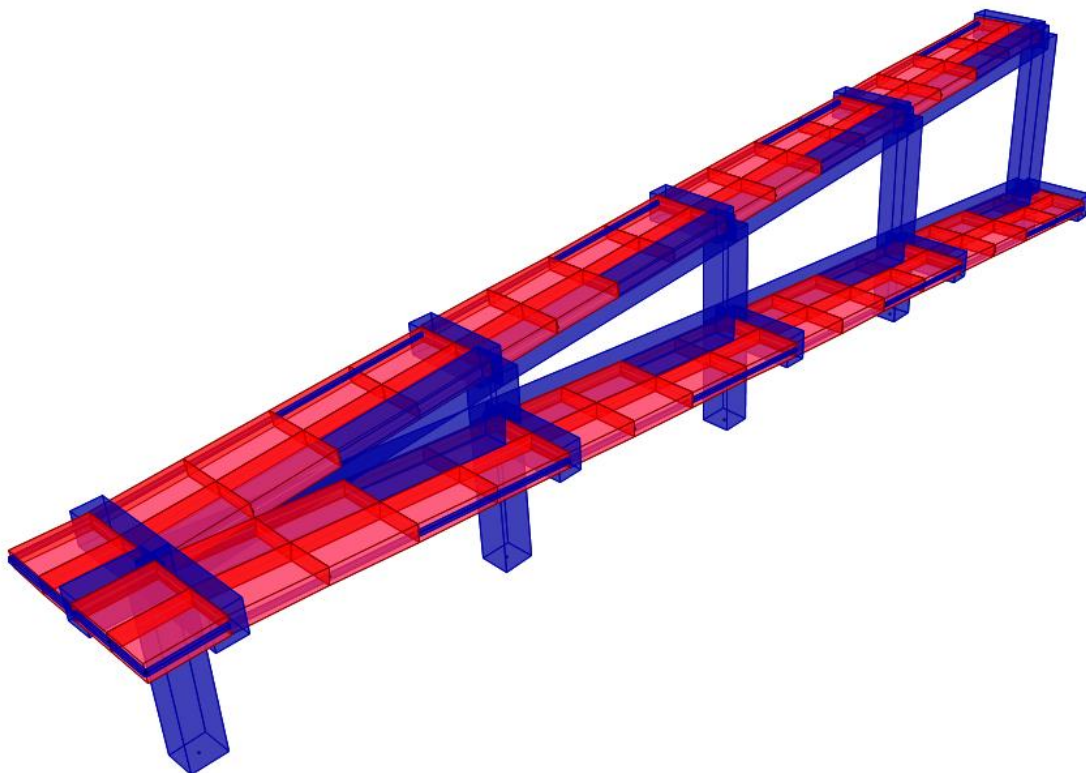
VISTA ESTRUCTURA RAMPA.
